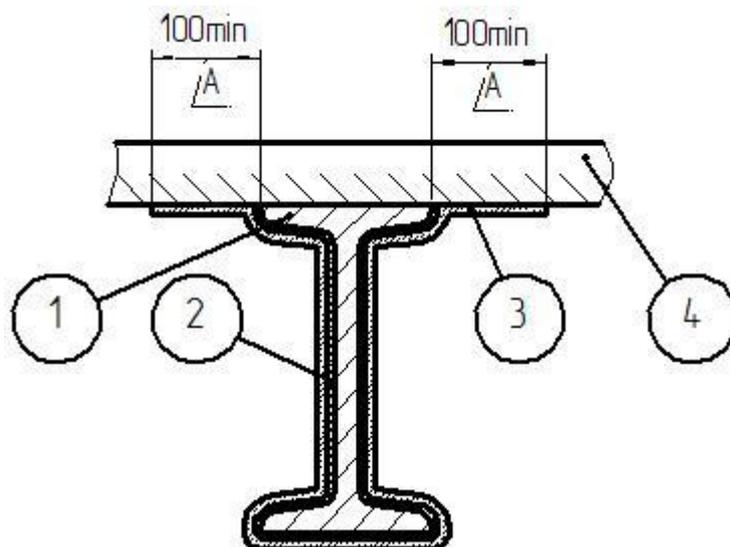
Устройство покрытия на поверхности металлоконструкций.
